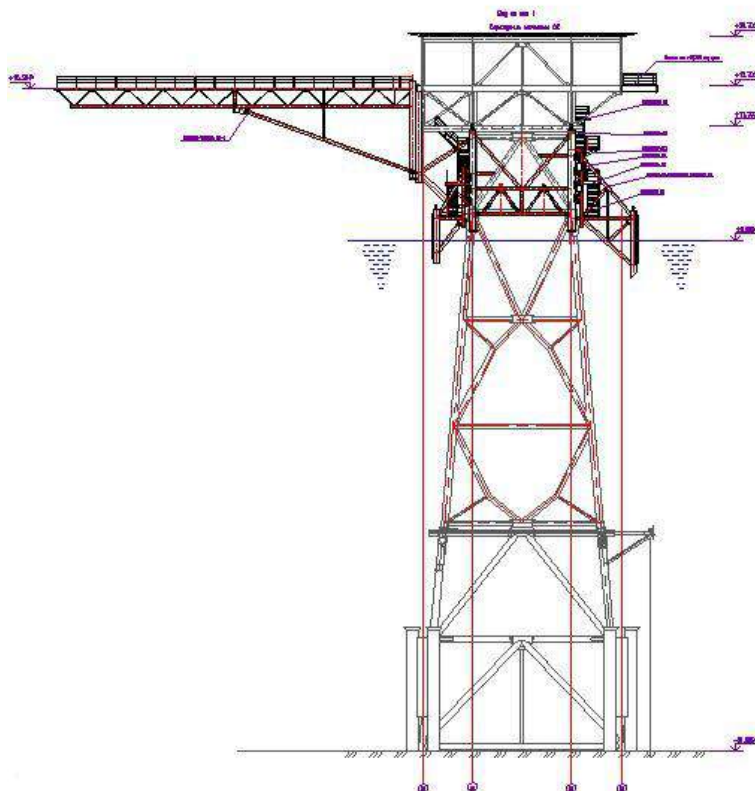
Общий вид блока. Вид по оси 1. Новая конструкция консоли под факел
